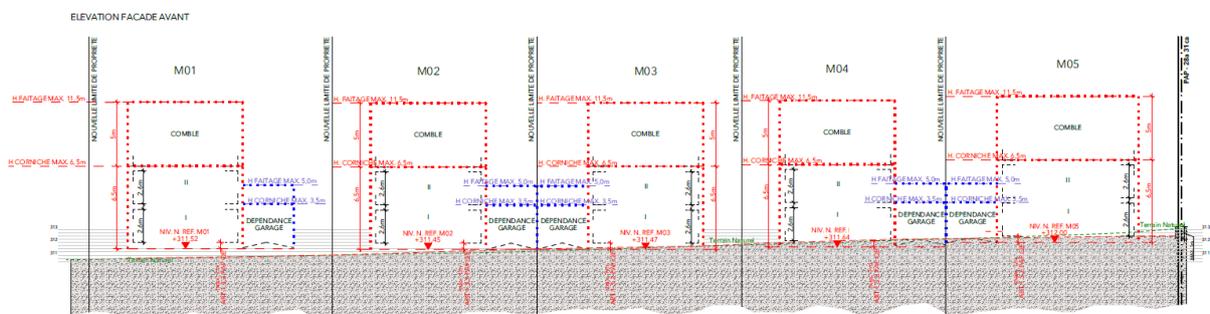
Elévation du projet d'aménagement particulier (source : Acom 04.2023)
